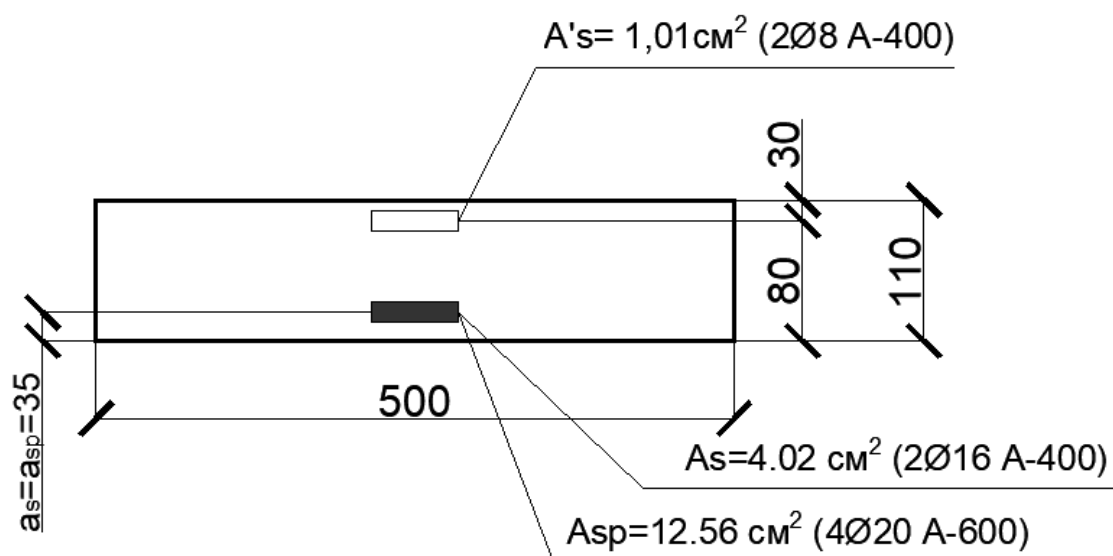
Размеры сечения полки ригеля и принятое армирование
